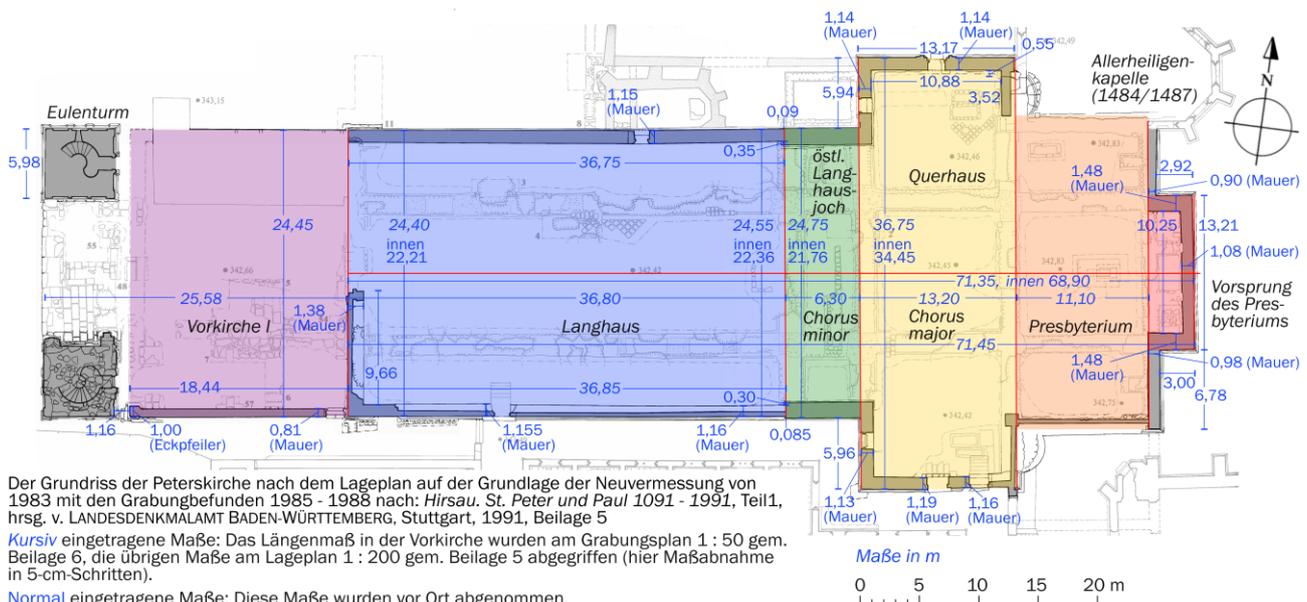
zeigt den Grundriss der Ruine nach dem Lageplan auf der Grundlage der Neuvermessung von 1983.²²⁴ Wo es möglich war, wurden die eingetragenen Maße mit Meterstab, Maßband und Laser-Entfernungsmesser vor Ort abgenommen. An der Basilika wurden diejenigen Maße, die nicht direkt gemessen werden konnten, am Lageplan mit dem Maßstab 1 : 200 abgegriffen. Maßstabbedingt erfolgte die Maßabnahme hier in 5-cm-Schritten. Die Mittelachse ist rot eingezeichnet, ebenso verschiedene Querachsen.
